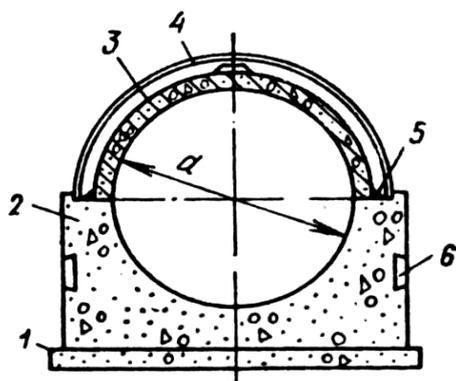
Водоотводящий коллектор: 1 – подготовка; 2 – бетонное основание; 3 – свод; 4 – бетонный пояс для заделки стыков свода; 5 – битум; 6 – пояс для крепления блоков основания
